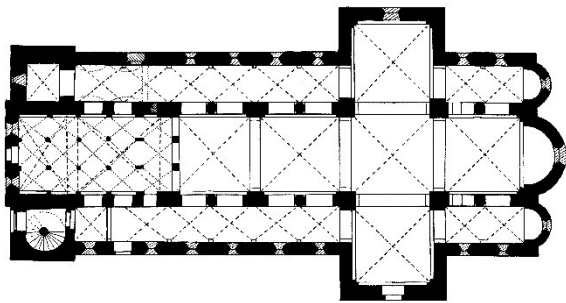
Grundriss der Klosterkirche Lippoldsberg
